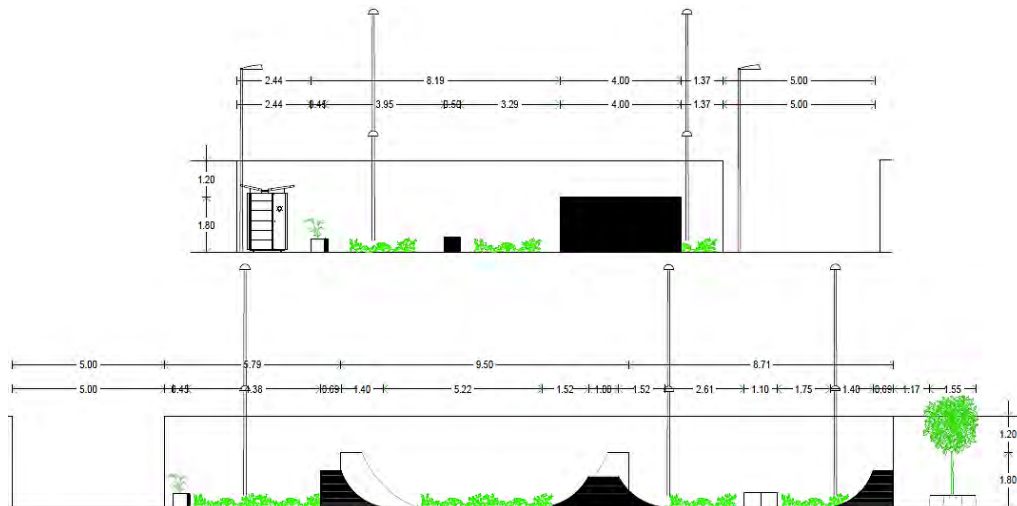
Corte transversal y longitudinal de la plaza 5.
